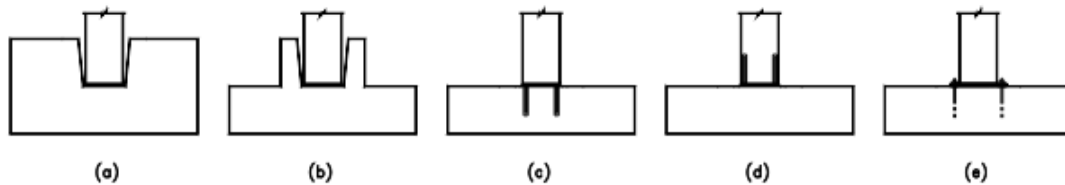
Ligação Pilar-Fundação, extraído de Lúcio [10]
